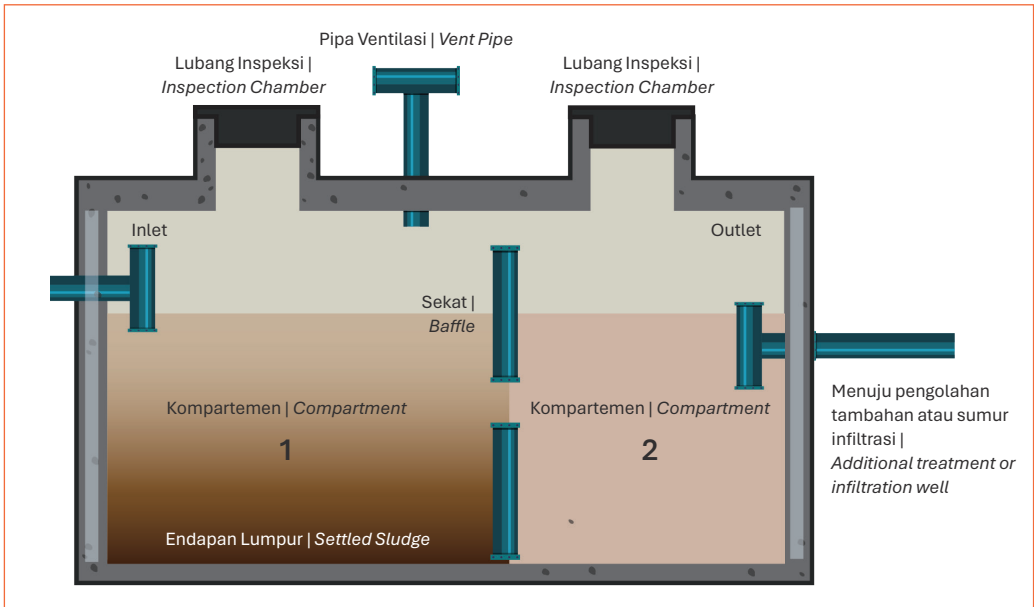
Pembangunan Septic Tank Sumber: najjahouses.com
